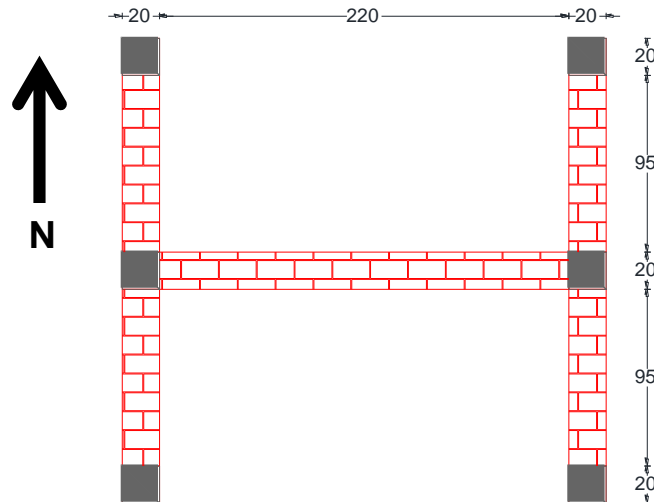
Ensayo de carga cíclica en muros H (vista en planta)
